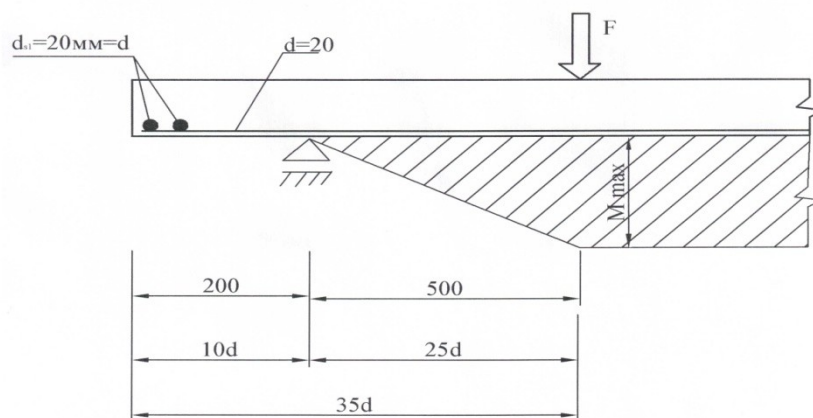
До визначення довжини анкерування поздовжньої розтягнутої арматури дослідних балок.
